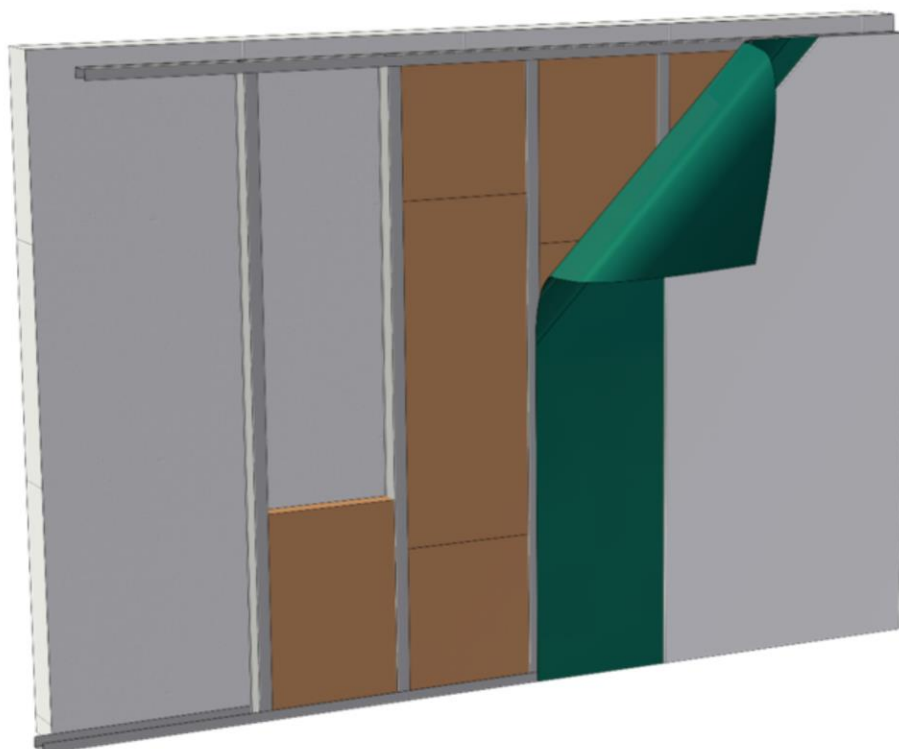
Isolation intérieur sur mur extérieur (maçonnerie ou béton) en ossature métallique
